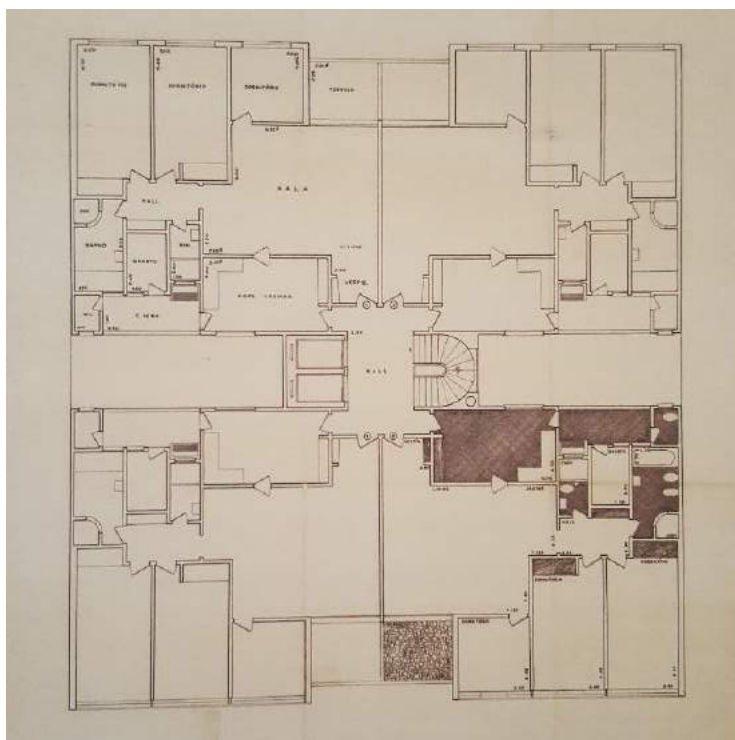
Planta tipo dos pavimentos - Edifício Primavera.
